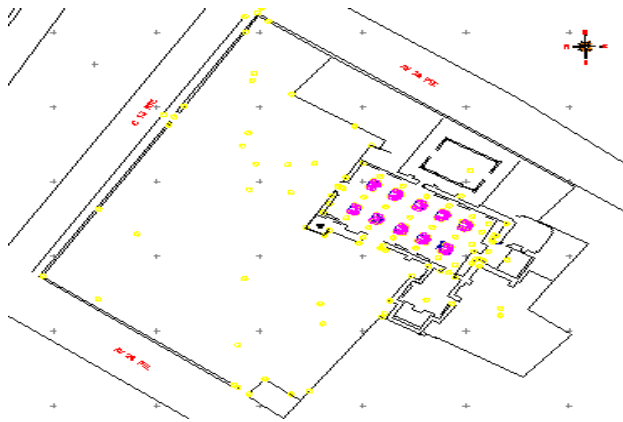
Planta del Conjunto del Templo de Santa Anita;
